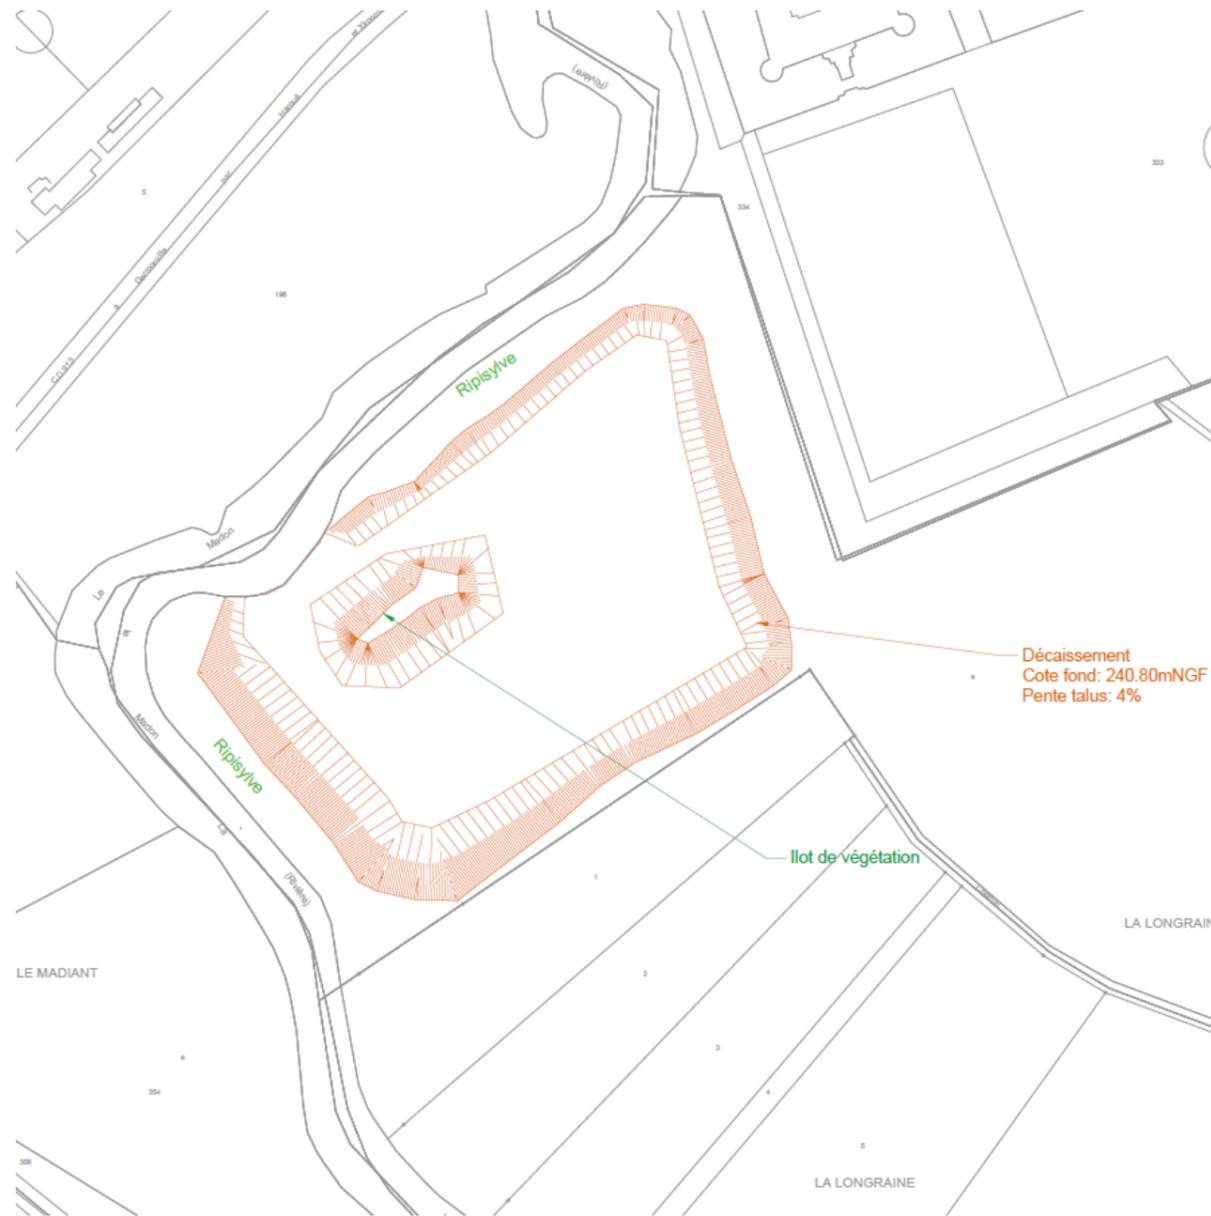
Extrait de vue en plan des aménagements de l'opération 5 — action 6.5 (décaissement) à Vaudeville — plan AVP (ARTELIA, mai 2021)
